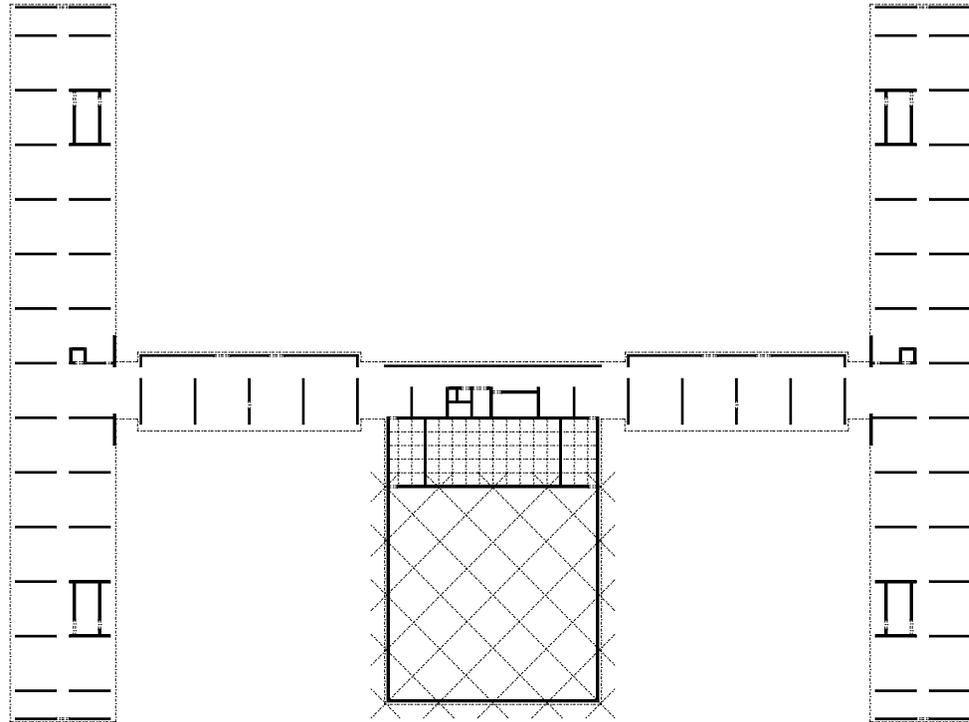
Tragstruktur Kloster Baldegg, Obergeschoss
